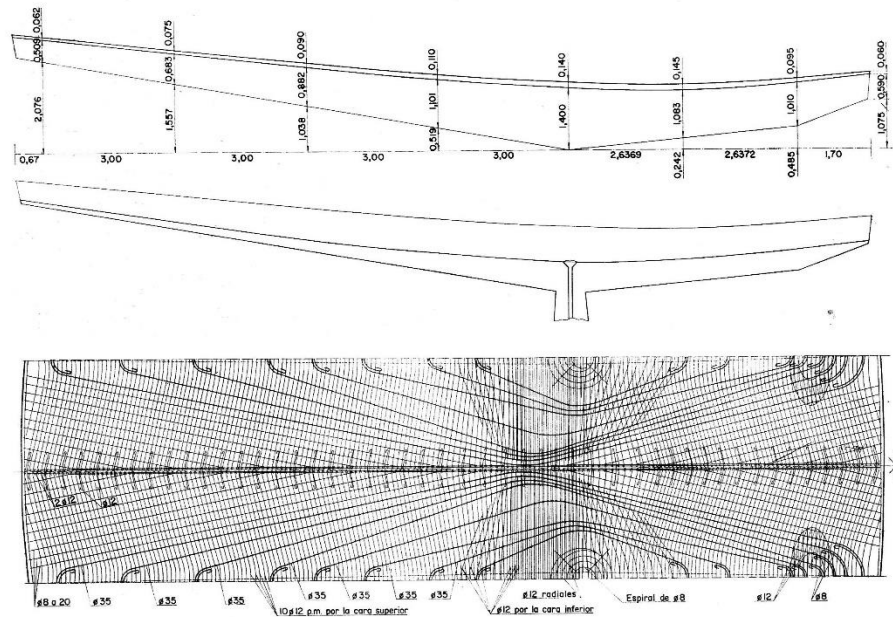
Sección longitudinal de la lámina y planta de armadura. (Fuente: Libro "Eduardo Torroja Ingeniero", 1999)
